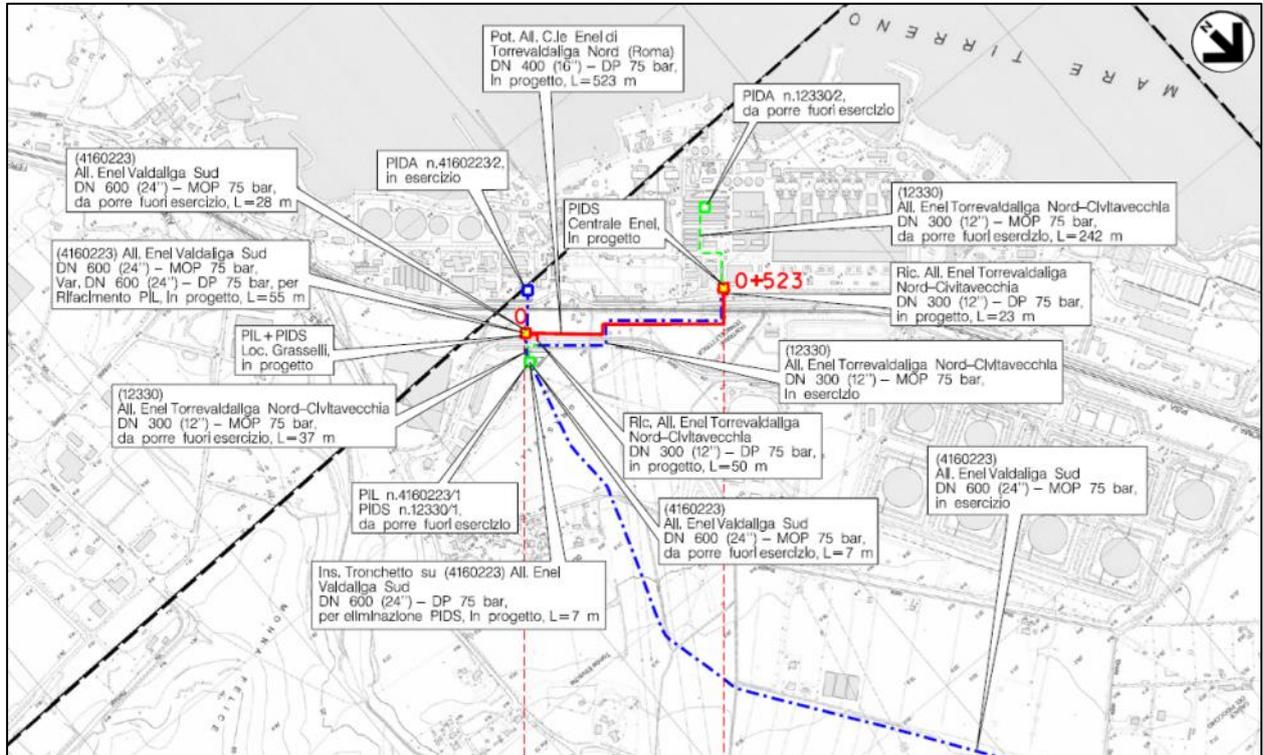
/B – Stralcio planimetrico con localizzazione del tracciato in progetto
